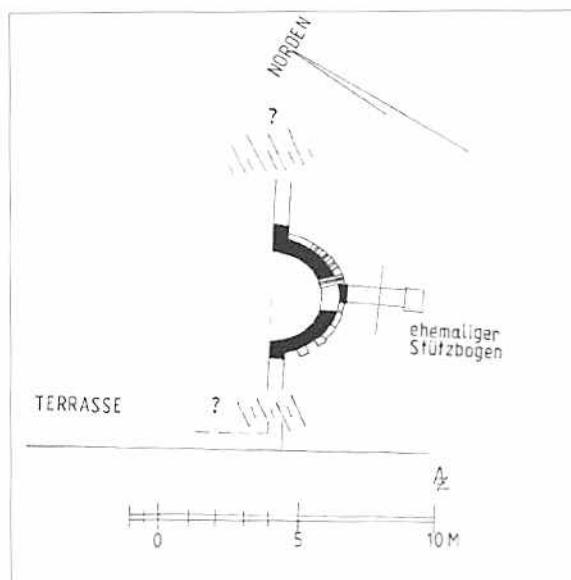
"Torre bizantina", planimetria / Byzantinischer 'Turm', Grundriß.
